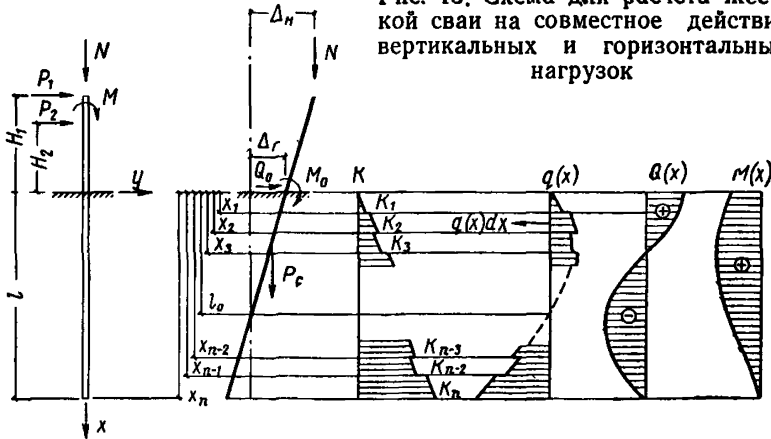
Схема для расчета жесткой сваи на совместное действие вертикальных и горизонтальных нагрузок
